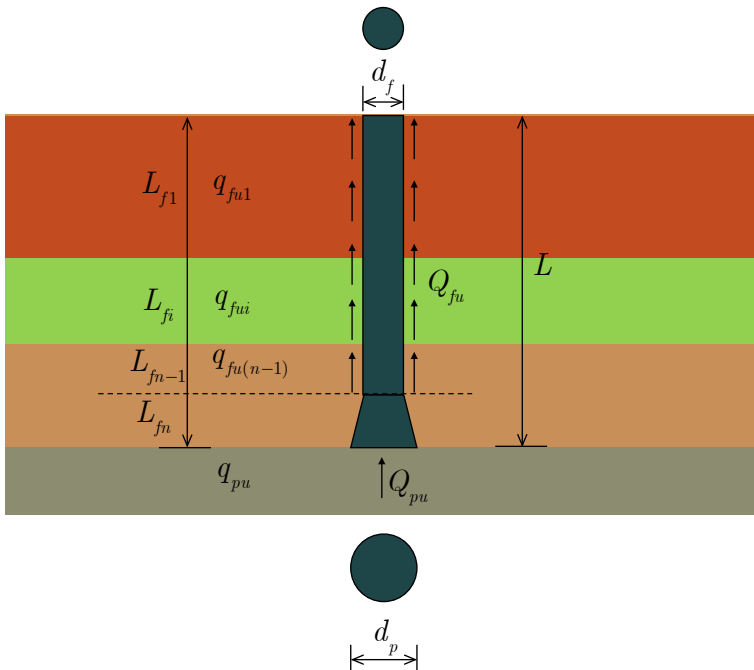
Capacidad de carga última vertical de un pilote excavado con campana
